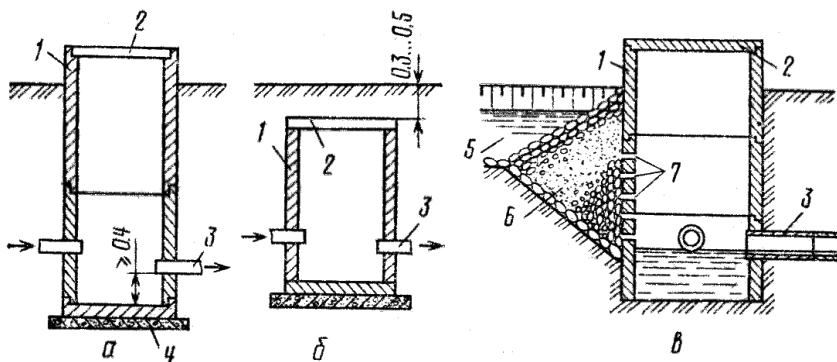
Оглядовий колодязь із залізобетонних кілець:
